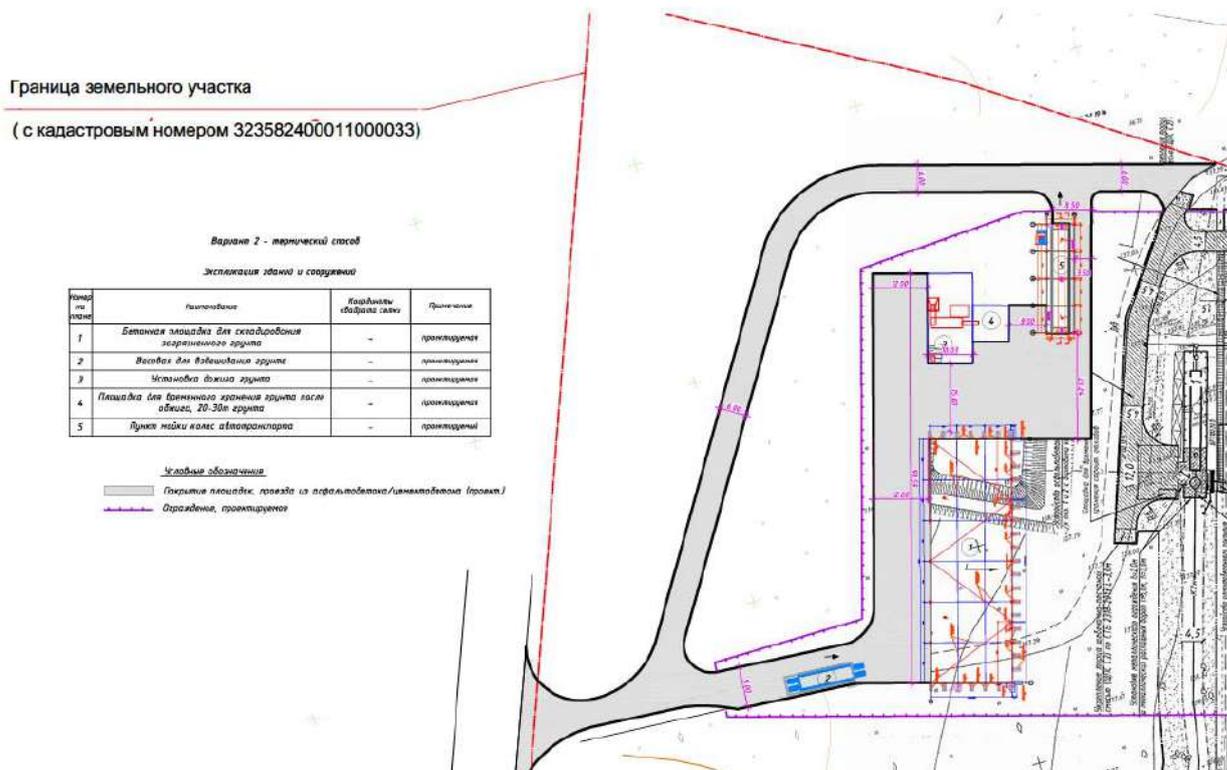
Схема генерального плана строительства объекта по использованию отходов производства термическим методом
